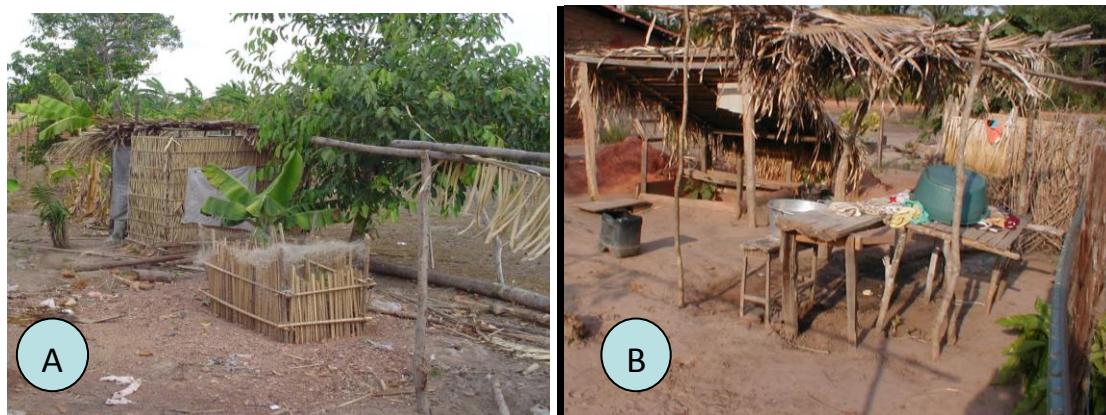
Extensões: A) Banheiro e Cercado Protetor de Plantas; B) Cobertura de Poço e Jirau de Lavagem.
